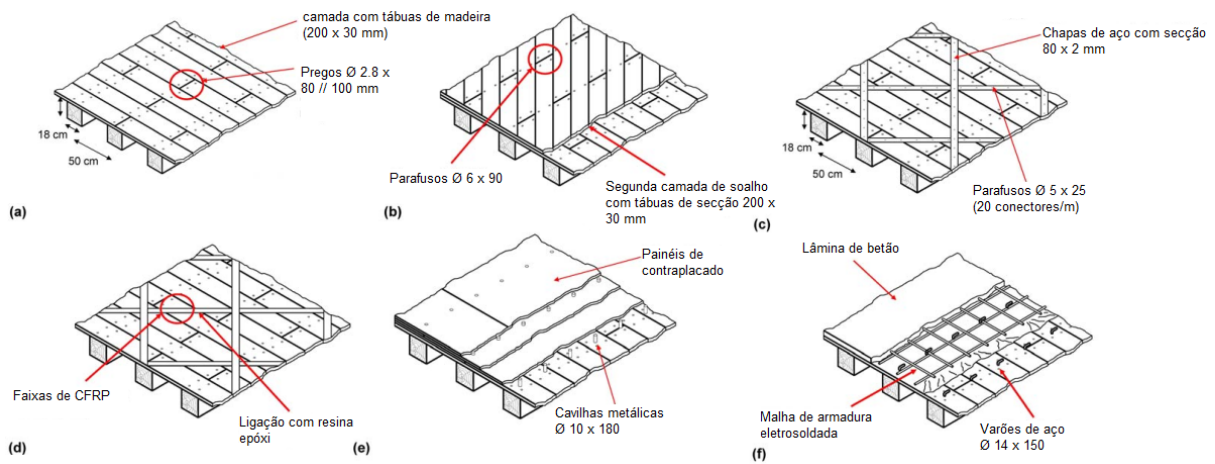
Reforços propostos por Piazza et al. (2008). a) Pavimento não reforçado; Reforço com: b) segunda camada de soalho; c) chapas de aço; d) faixas de CFRP; e) painéis de contraplacado; f) lâmina de betão. (Adaptado de Piazza et al., 2008)
